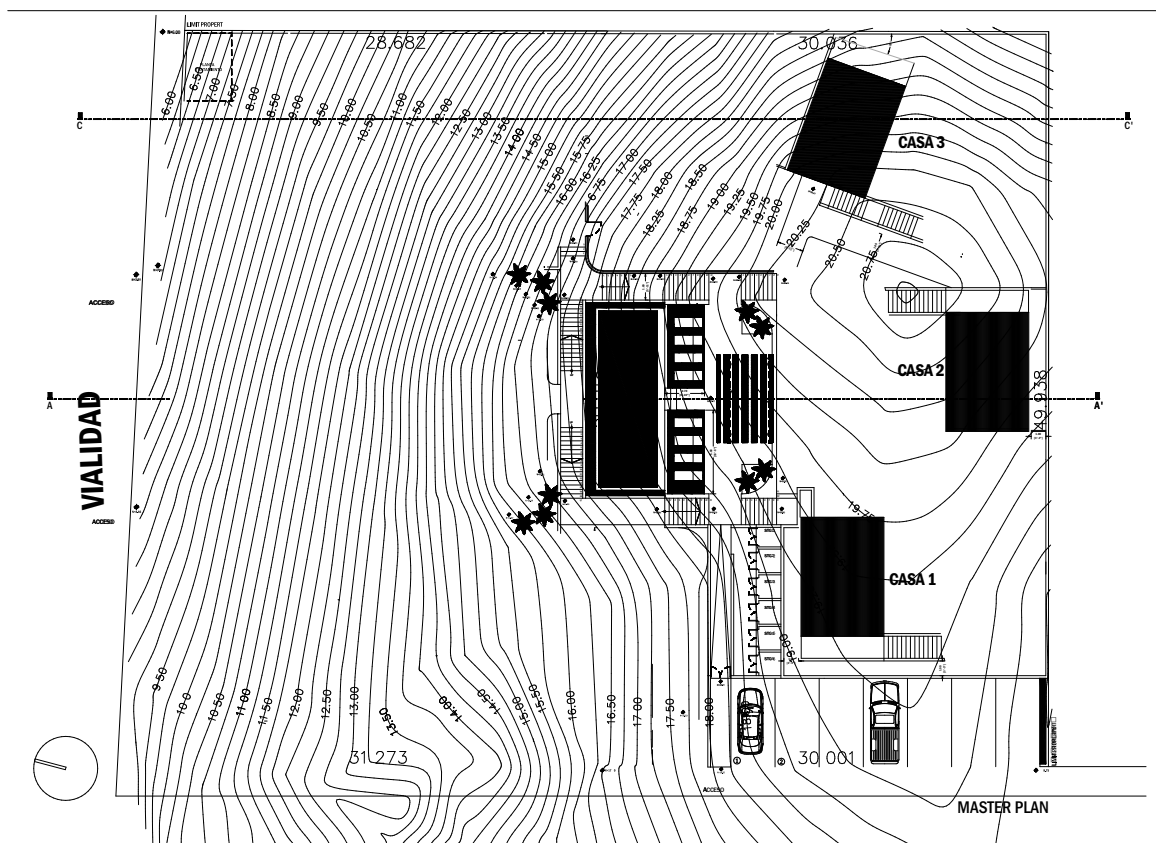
Planta de conjunto de la casa habitación de uso residencial turístico.
